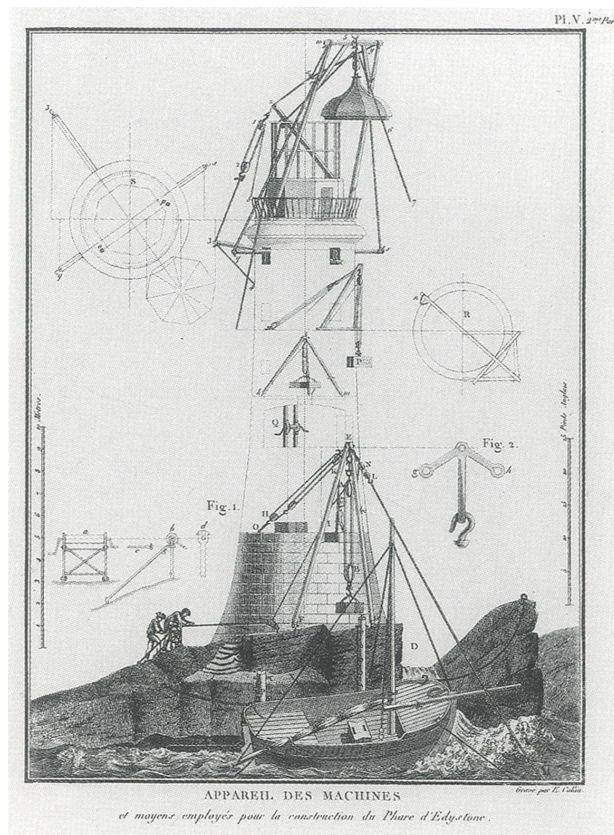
Faro de Eddystone construido por Smeaton [9]
